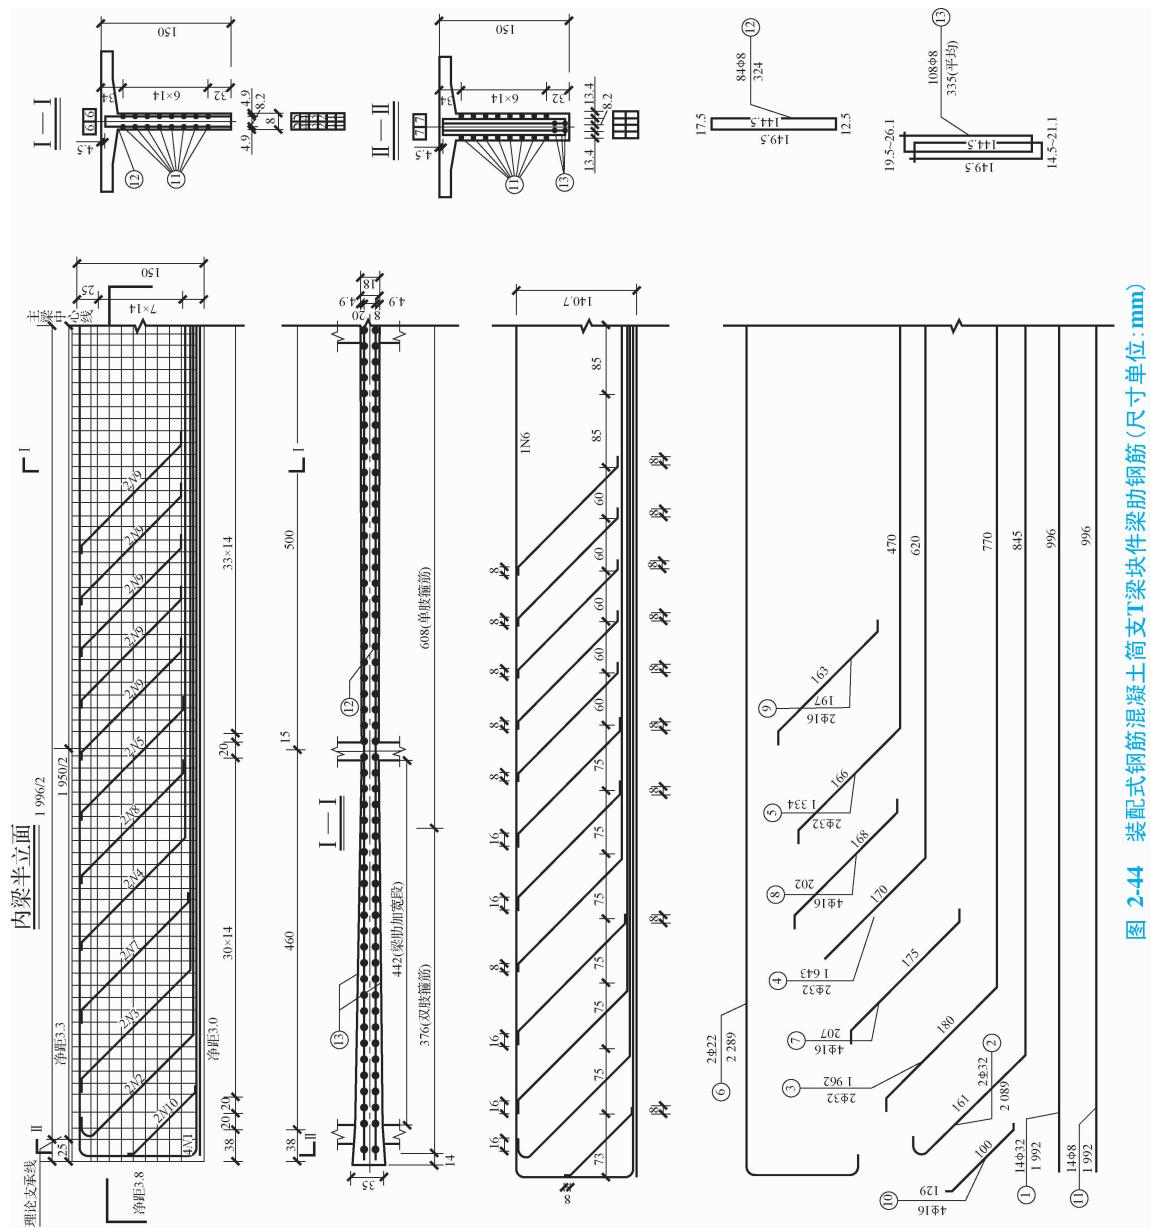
装配式钢筋混凝土简支 T 梁块件梁肋钢筋(尺寸单位:mm)
